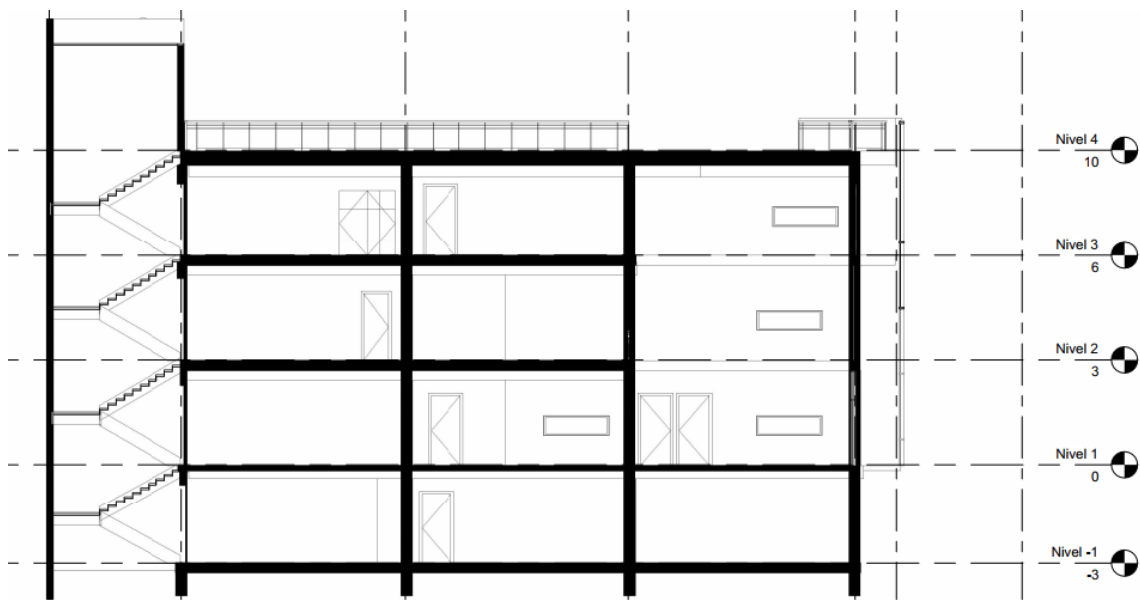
Corte transversal que pasa por el eje 9 cortando pilares y vigas (2021)
